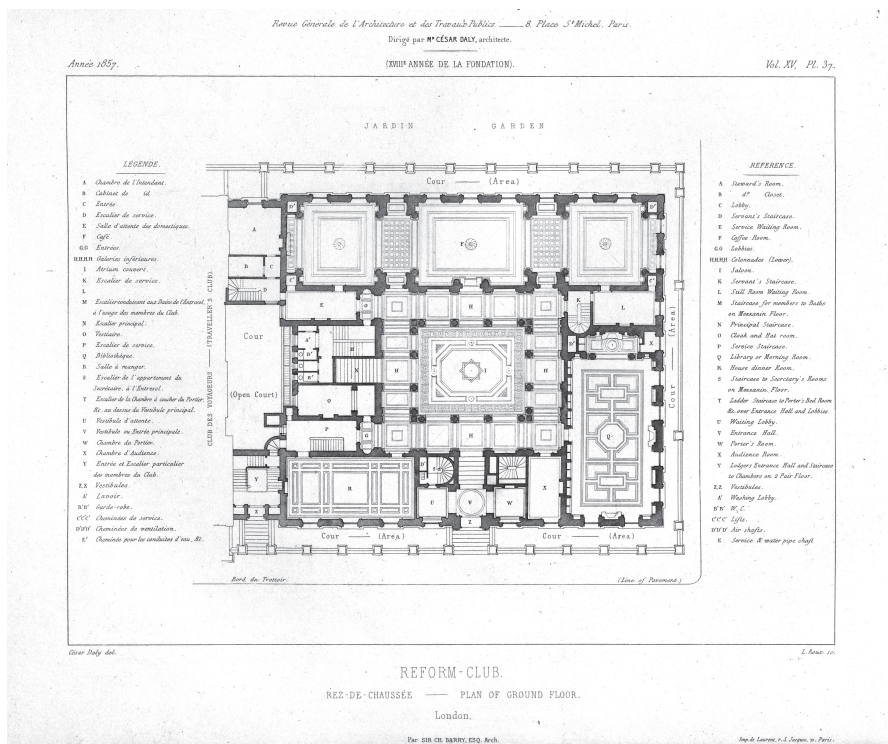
Grundriss des Erdgeschosses des *Reform Club*.
